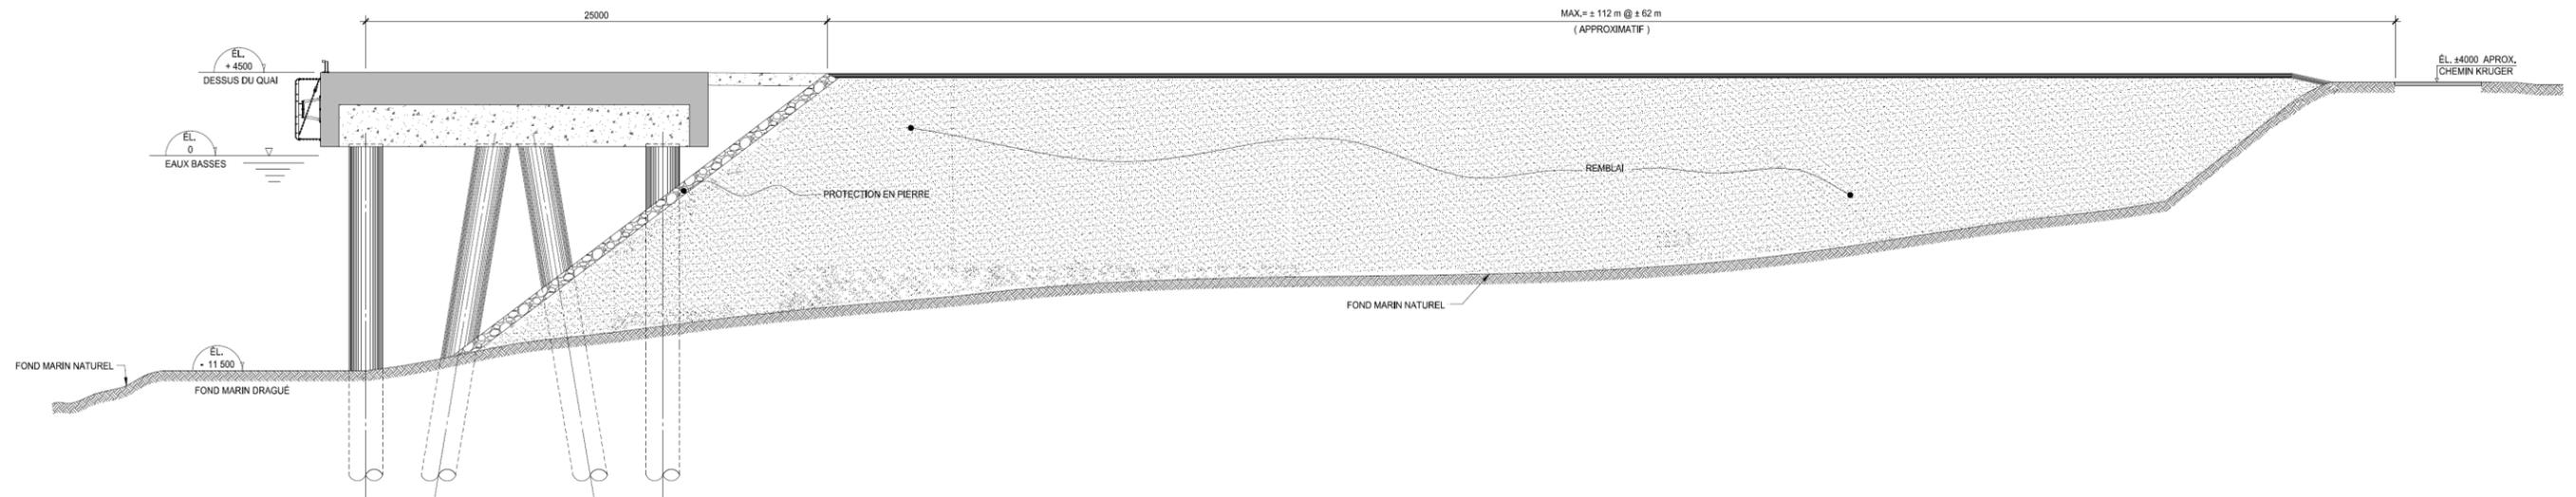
Coupe-type de la variante 4 -Dalle sur pieux avec entreposage
